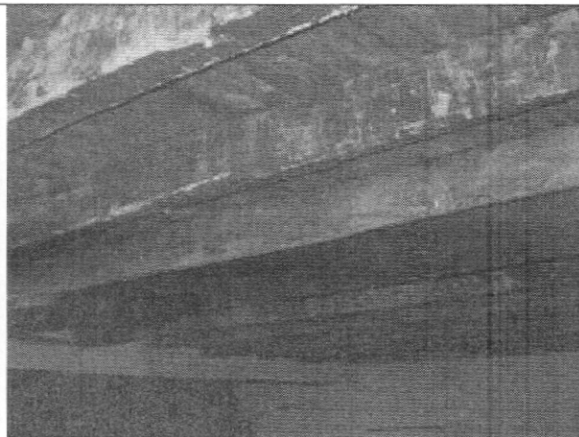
Entrepiso en madera zona posterior, deterioro y deflexión en vigas.
